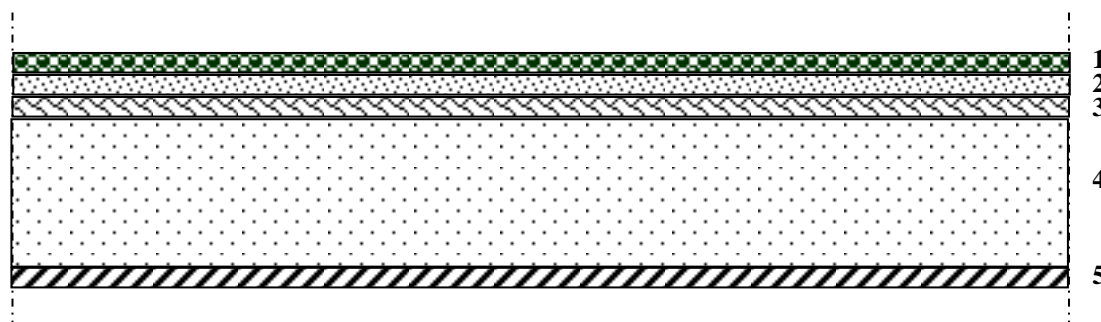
Coupe verticale du plancher courant à dalle pleine.
